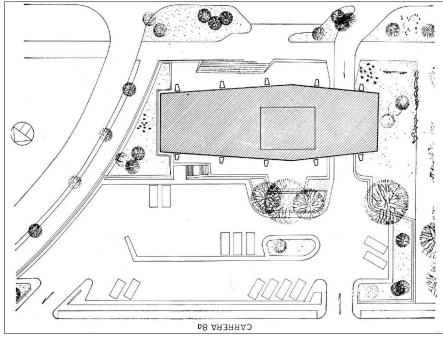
Planta proyecto original de Pan American Life Insurance Edificio Teusacá.
